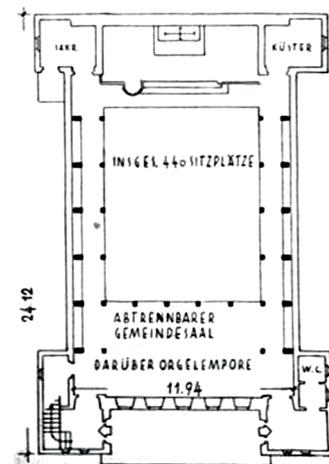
Grundriss, Schnitt, Typ A
